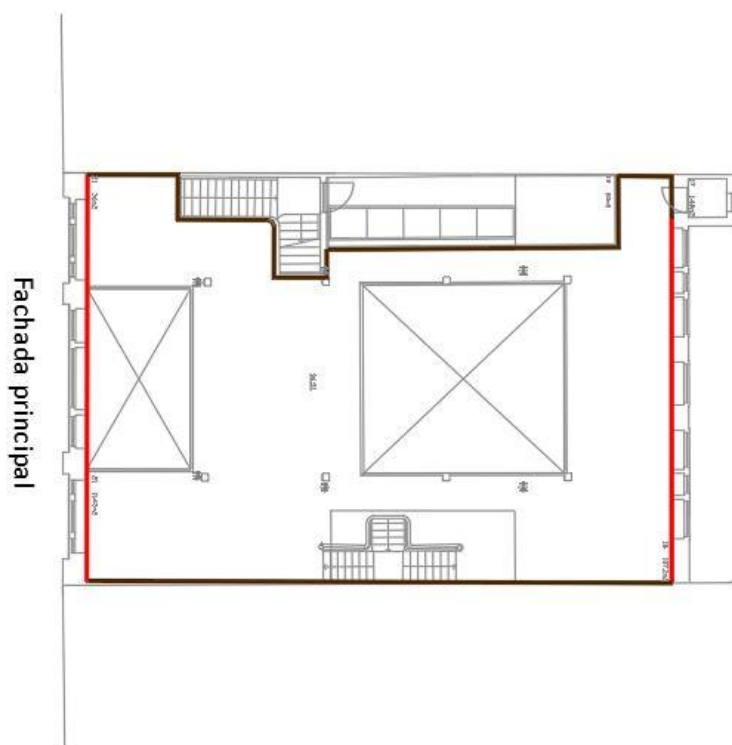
Planta do piso 1 com a marcação das envolventes e requisitos dos pavimentos
